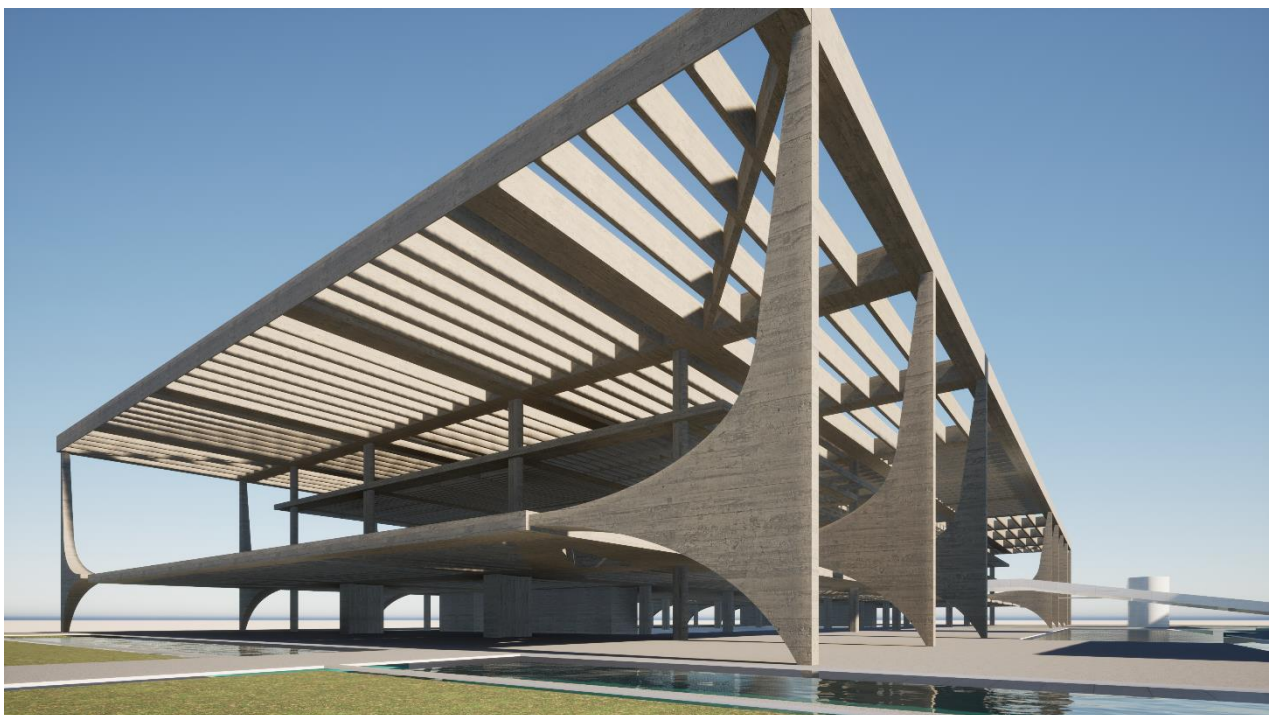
Trama da laje da cobertura do Palácio do Planalto. Fonte: Autoral.
